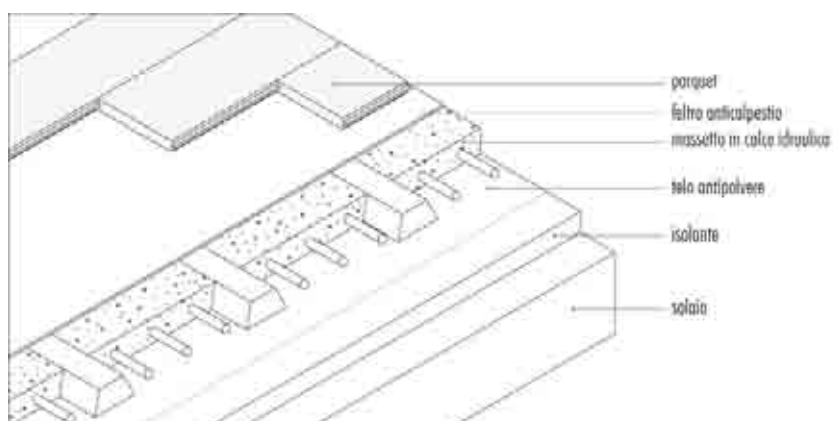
Pavimentazione in legno su massetto radiante in calce idraulica.
